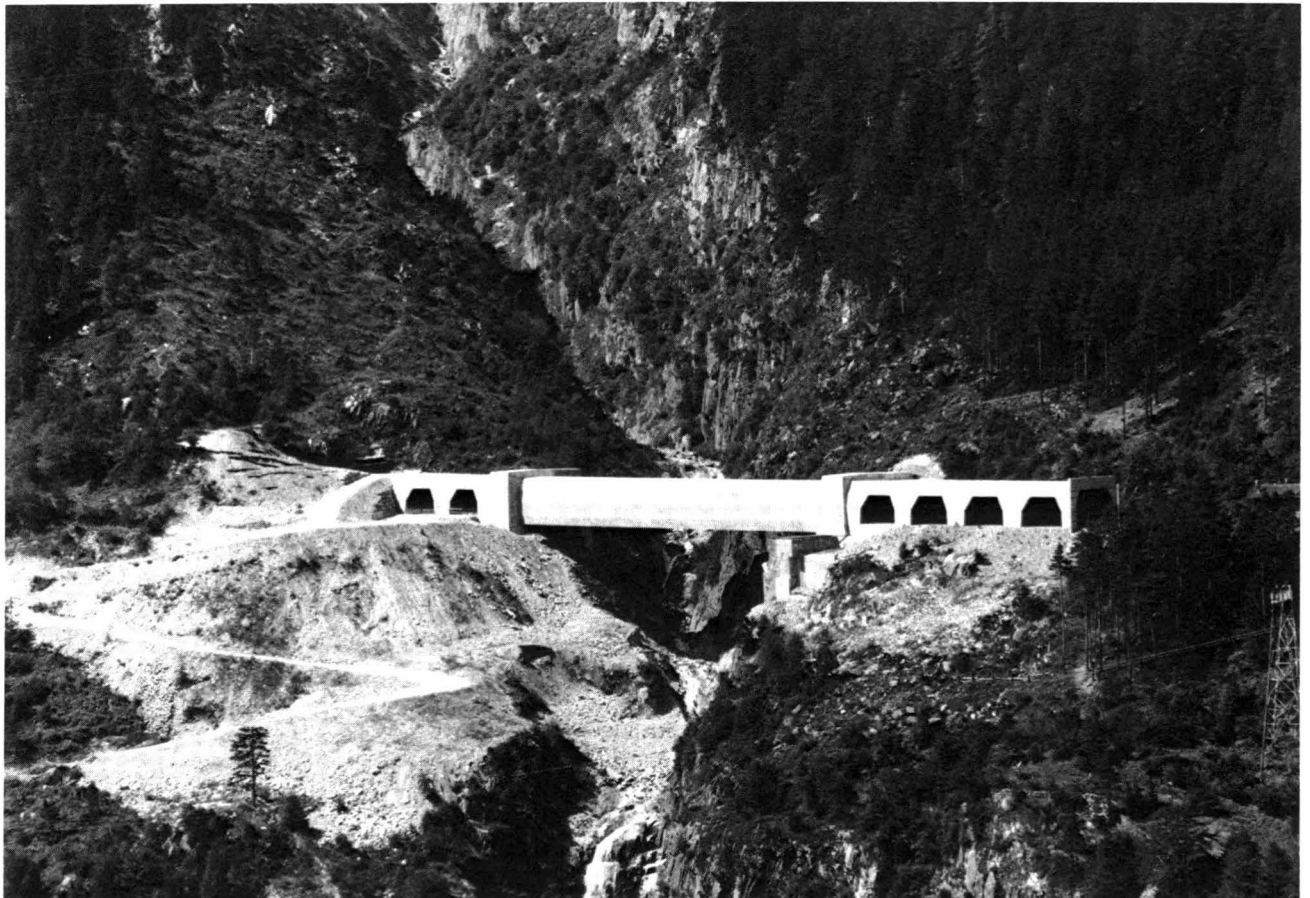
Ansicht der Baustelle mit Einzugsgebiet der Lawinen (oben) und Lawinenzug begrenzt durch den noch stehenden Wald – Vue du chantier avec la zone exposée à la chute des avalanches (en haut) et le couloir délimité latéralement par la forêt encore existante – View on site avalanche exposed zone (above) and the clearing due to avalanches delimited by the still standing forest
